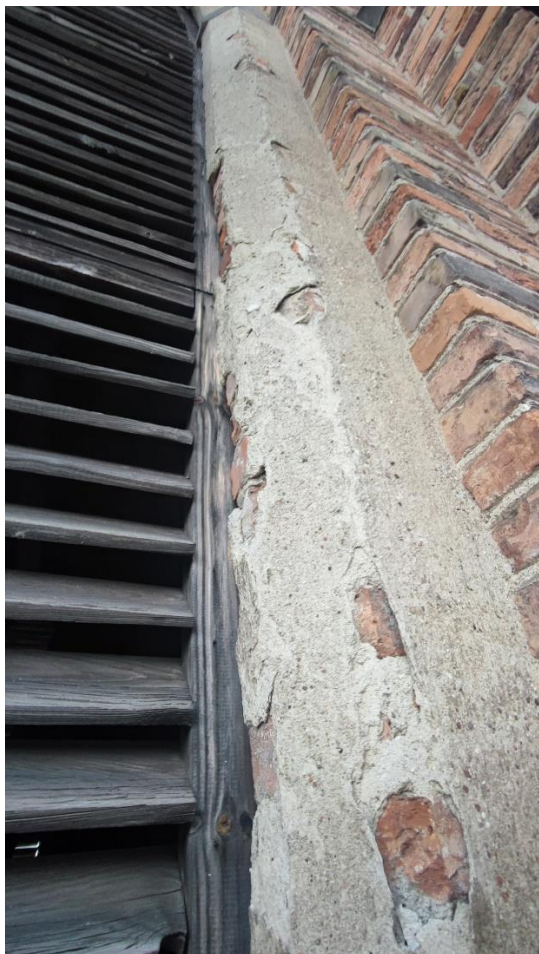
Stan elewacji po usunięciu betonowych uzupełnień w cegle z okresu powojennych prac konserwatorskich
